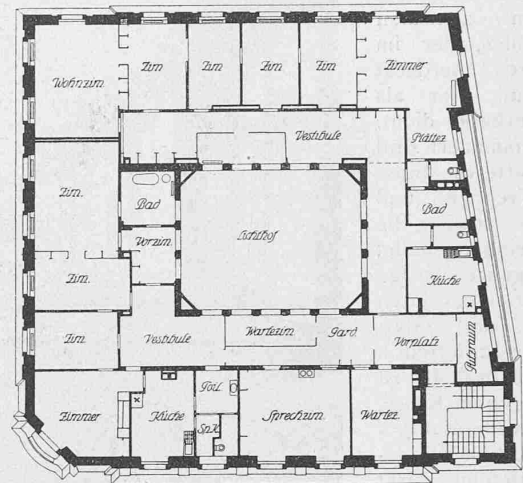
Grundriss vom Dachgeschoss.
